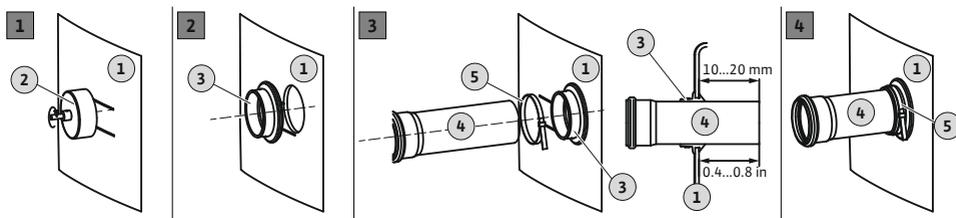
Instalación de la junta de entrada y del tubo de entrada
